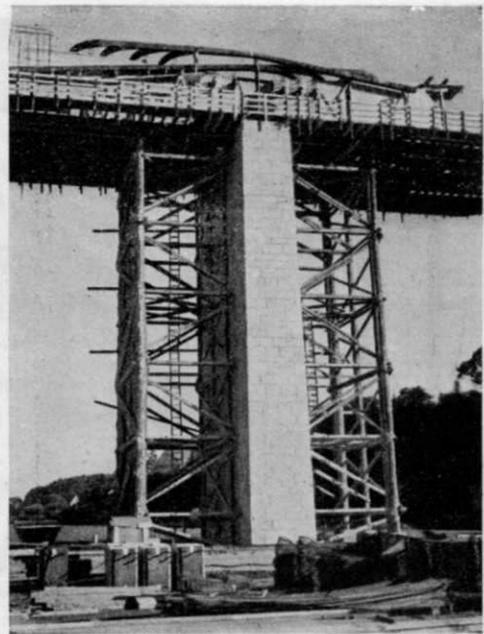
Il ponte presso Untermachtal in costruzione: particolare - Giunzione degli elementi di tensione sul pilone.
